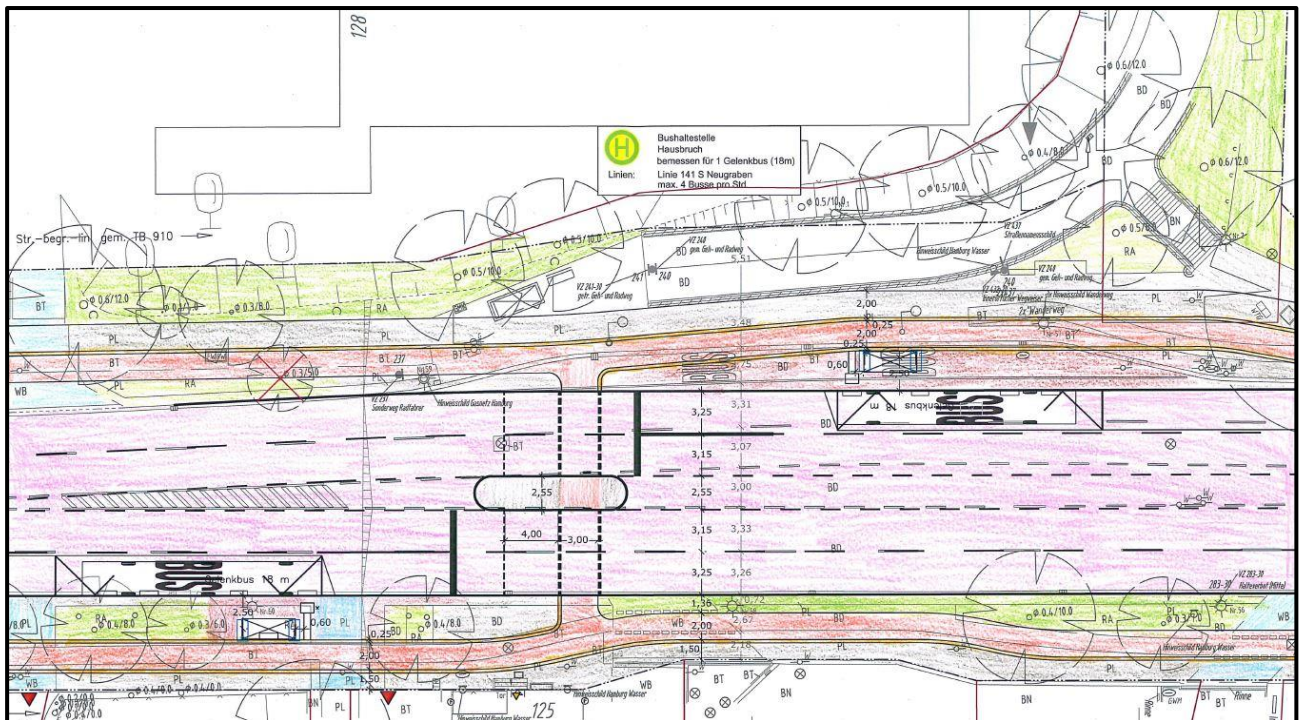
Variante: Fußgänger- / Radfahrerquerung – Cuxhavener Straße (Haltestelle Hausbruch)
